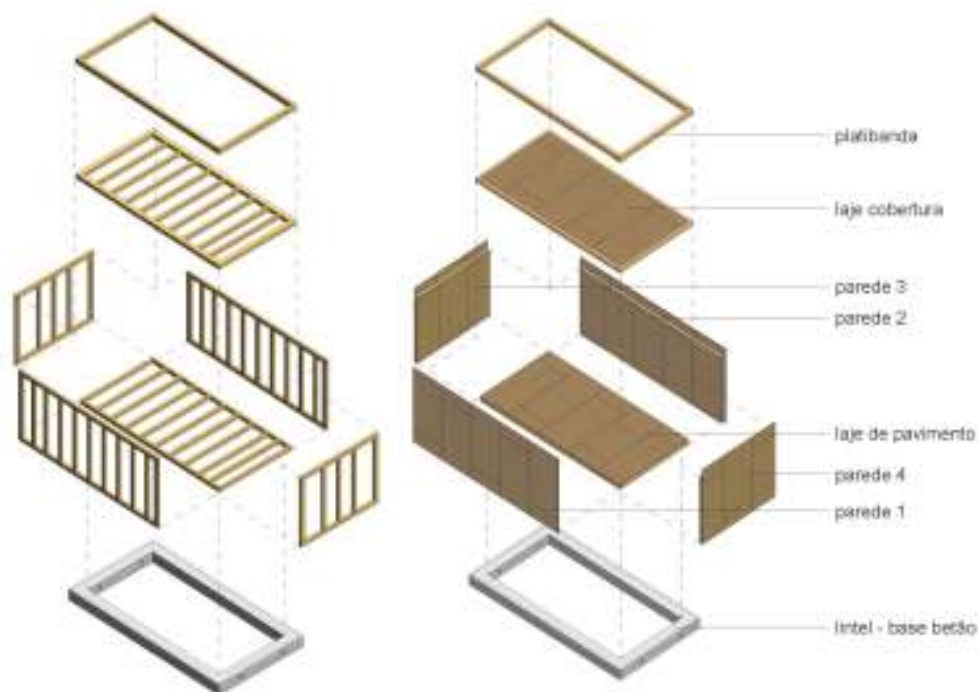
Conjugação e ligação dos vários elementos modulares que constituem o módulo tipo.
